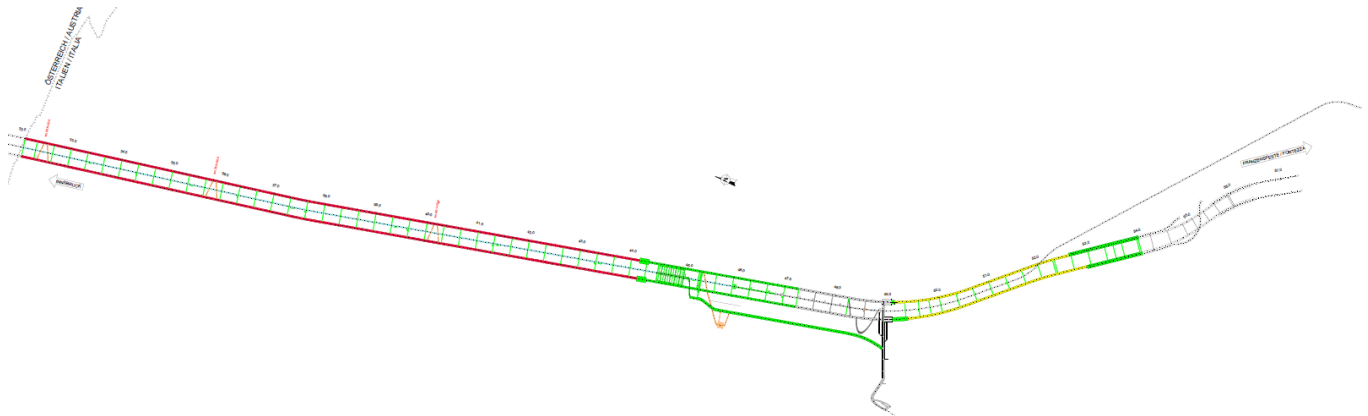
Schematischer Lageplan des Baulos Muls 2-3
